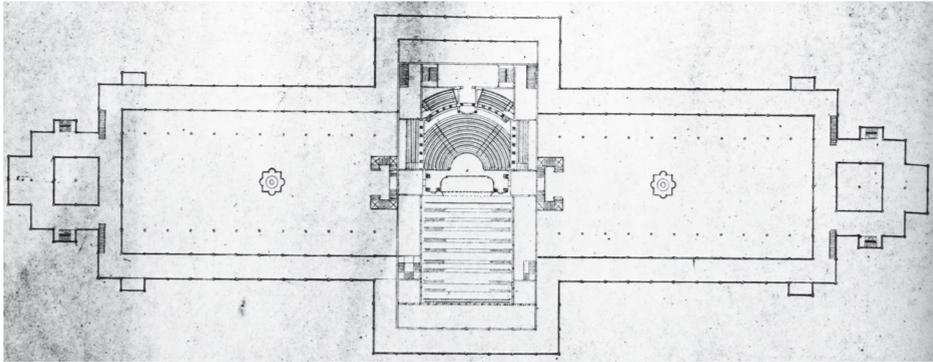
Projekt A. Grundriss des gesamten Glaspalasts
